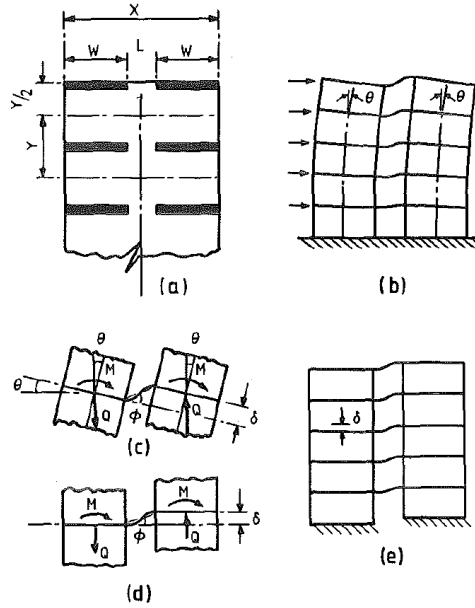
Acciones estructurales de un muro sometido a cargas laterales (Coull & Chee, 1983).
